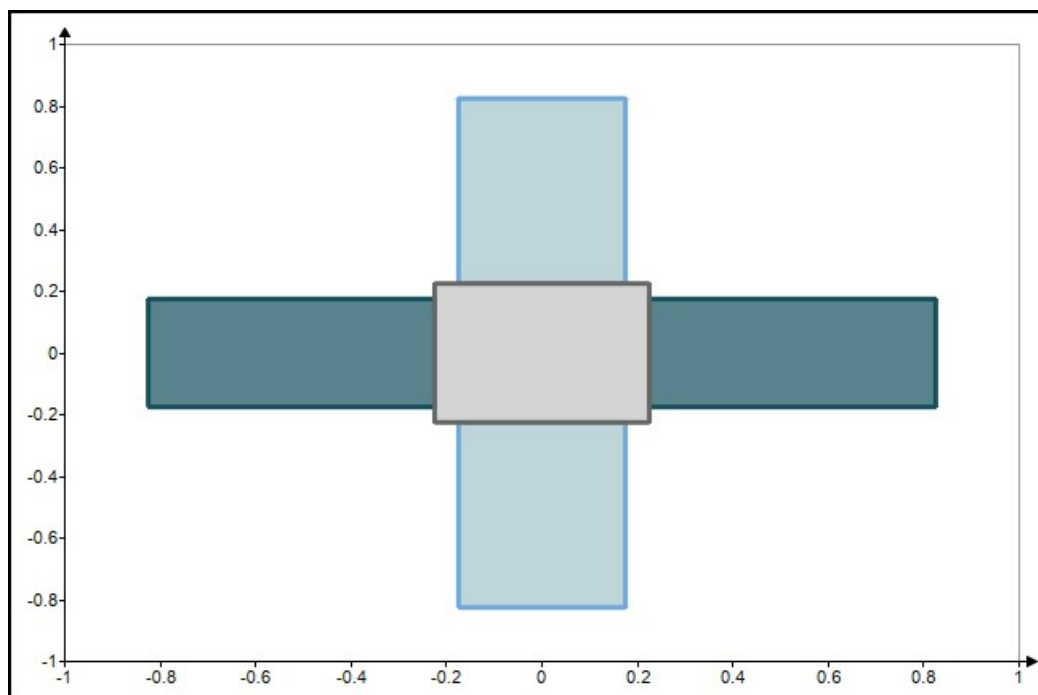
Vista en planta del nudo Viga-Columna.5. Acero transversal requerido en el nudo
